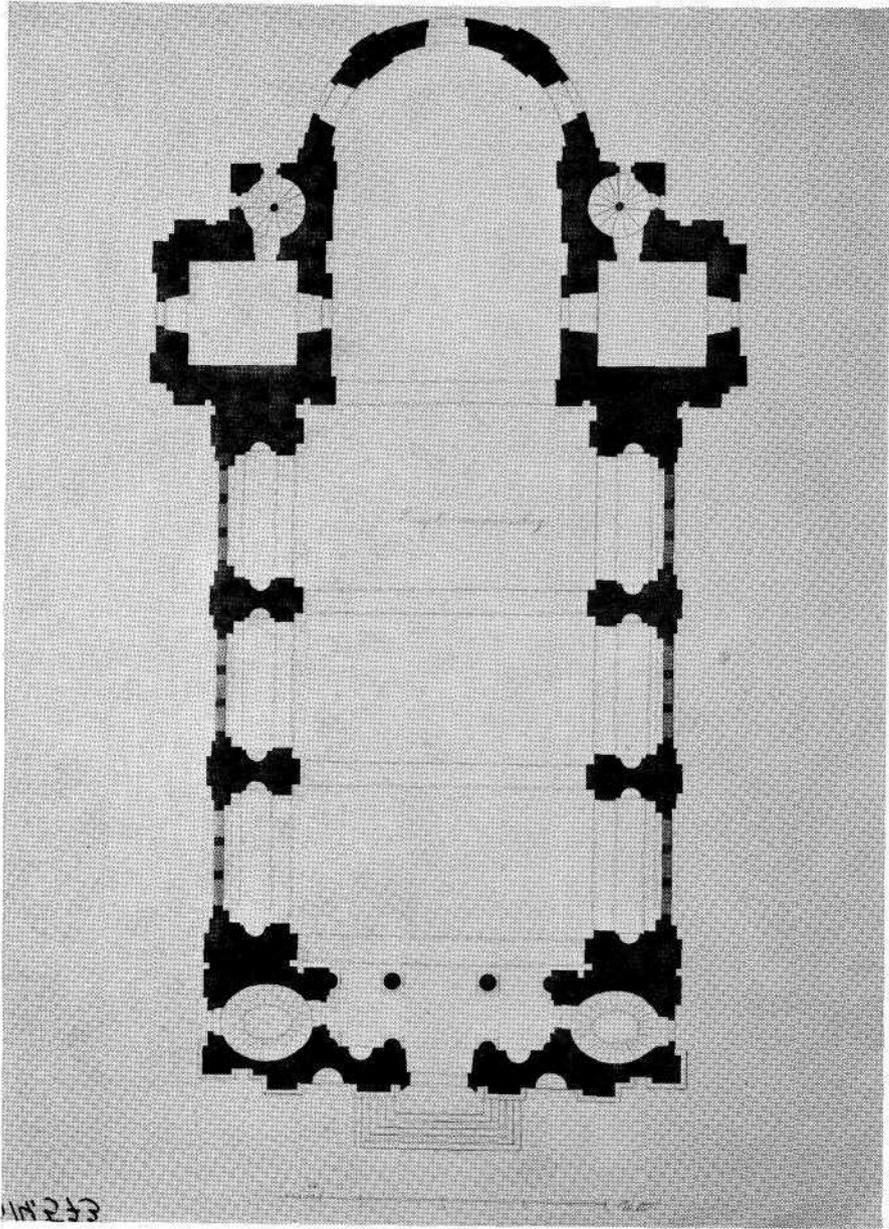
Altbunzlau, Wallfahrtskirche, Grundriß
